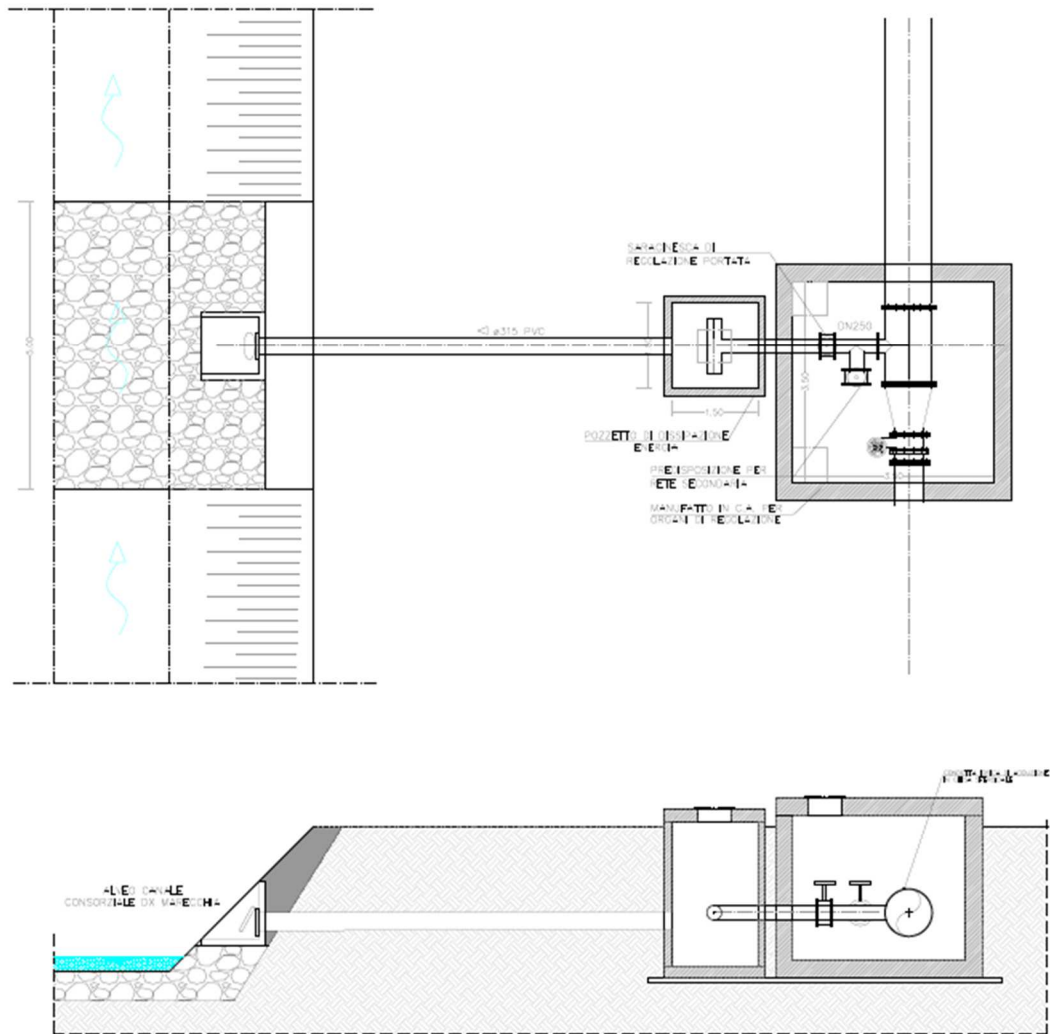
Particolare tipico nodo di restituzione al canale Dx Marecchia e predisposizione per collegamento futura rete secondaria
